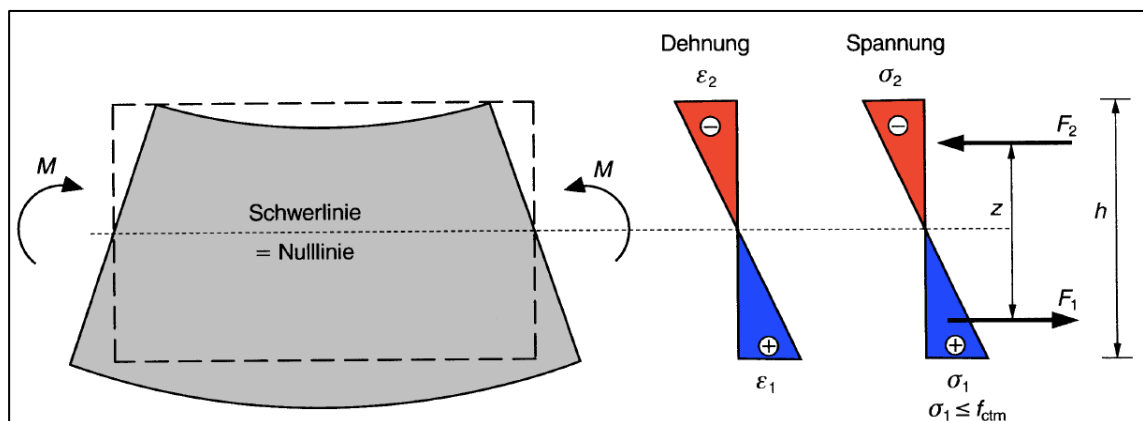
Stahlbetonbauteil unter Biegung, vor Rissbildung [57]
